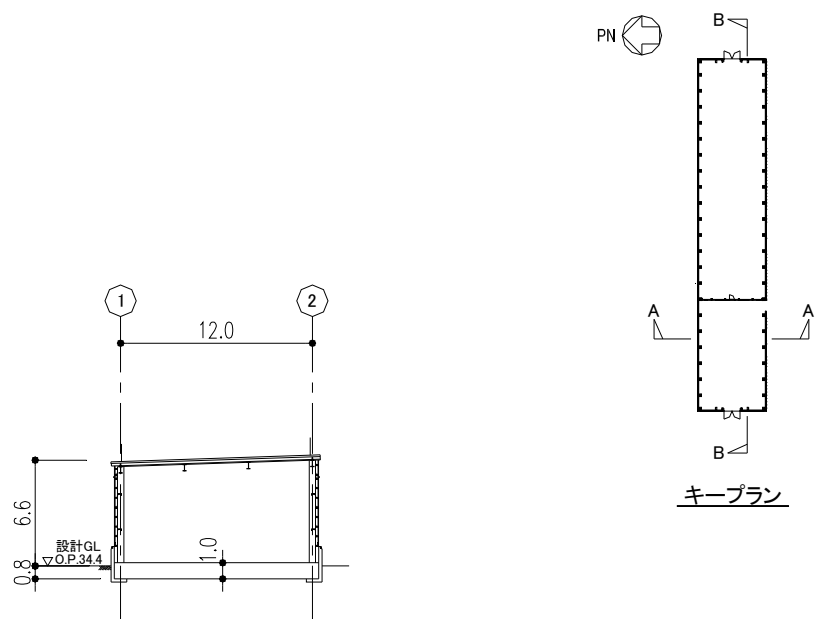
5 設備棟 A-A断面図 (NS 方向) (単位 : m)
